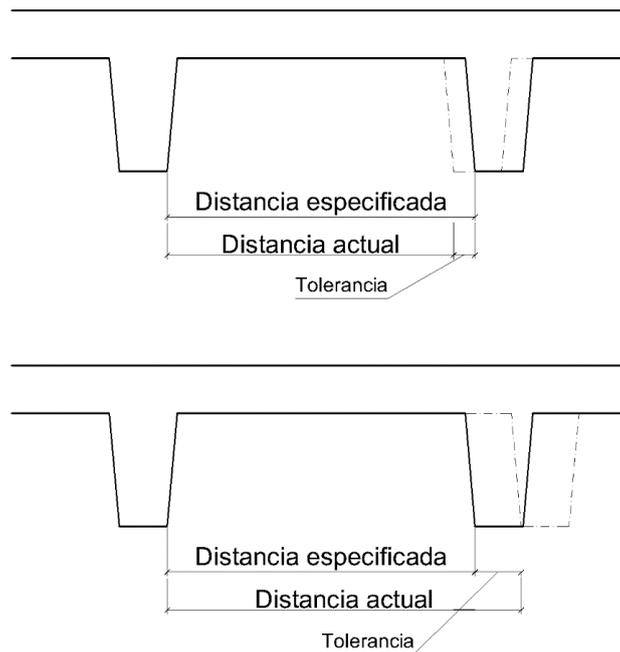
Distancia entre elementos adyacentes seccionados en un plano vertical
